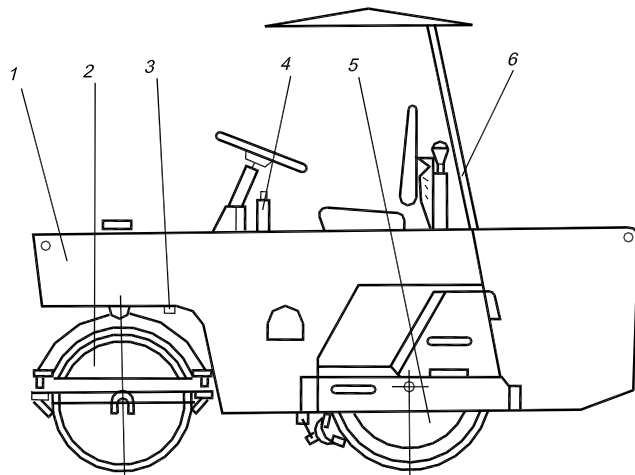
Общий вид самоходного катка ДУ-54А
